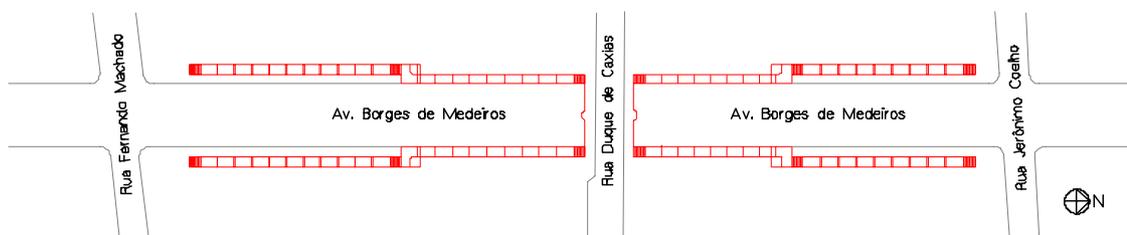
Planta Baixa esquemática do projeto de Manoel Itaquí para o Viaduto.
